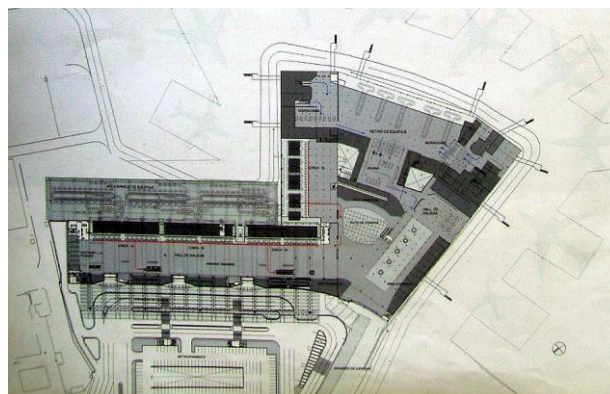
Planta Baja de la nueva Terminal A. Fuente: Revista Summa + n° 46
